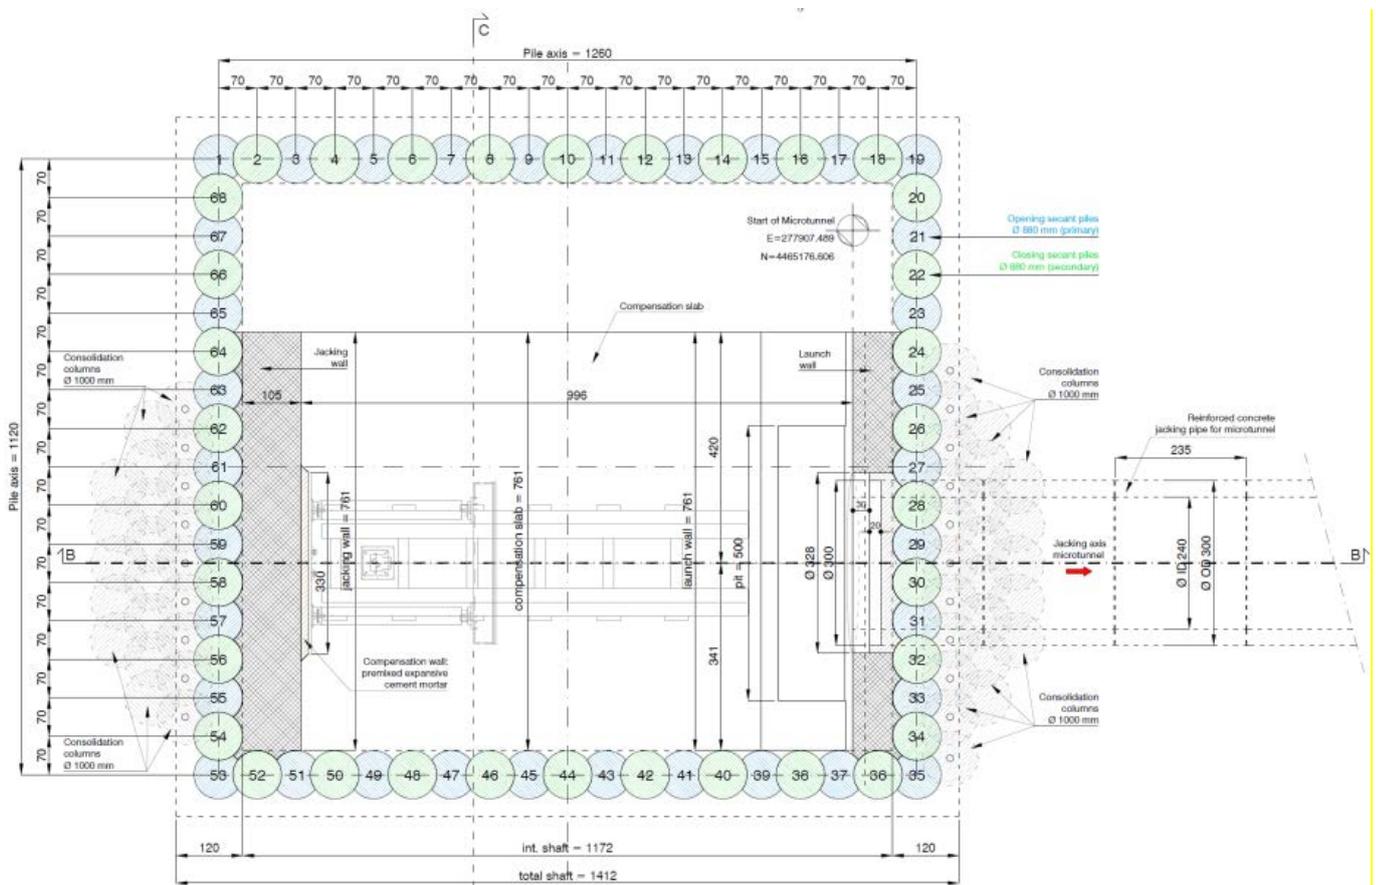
/D – Pozzo di spinta – pali secanti, vista in pianta
